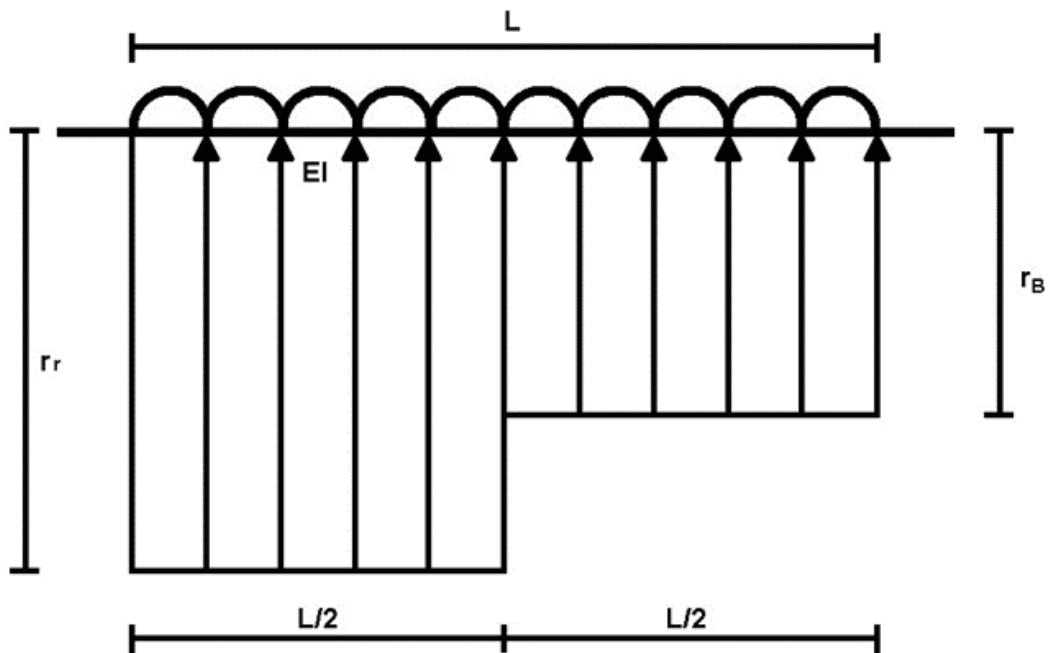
Geometría y cargas en la barra de cimentación
